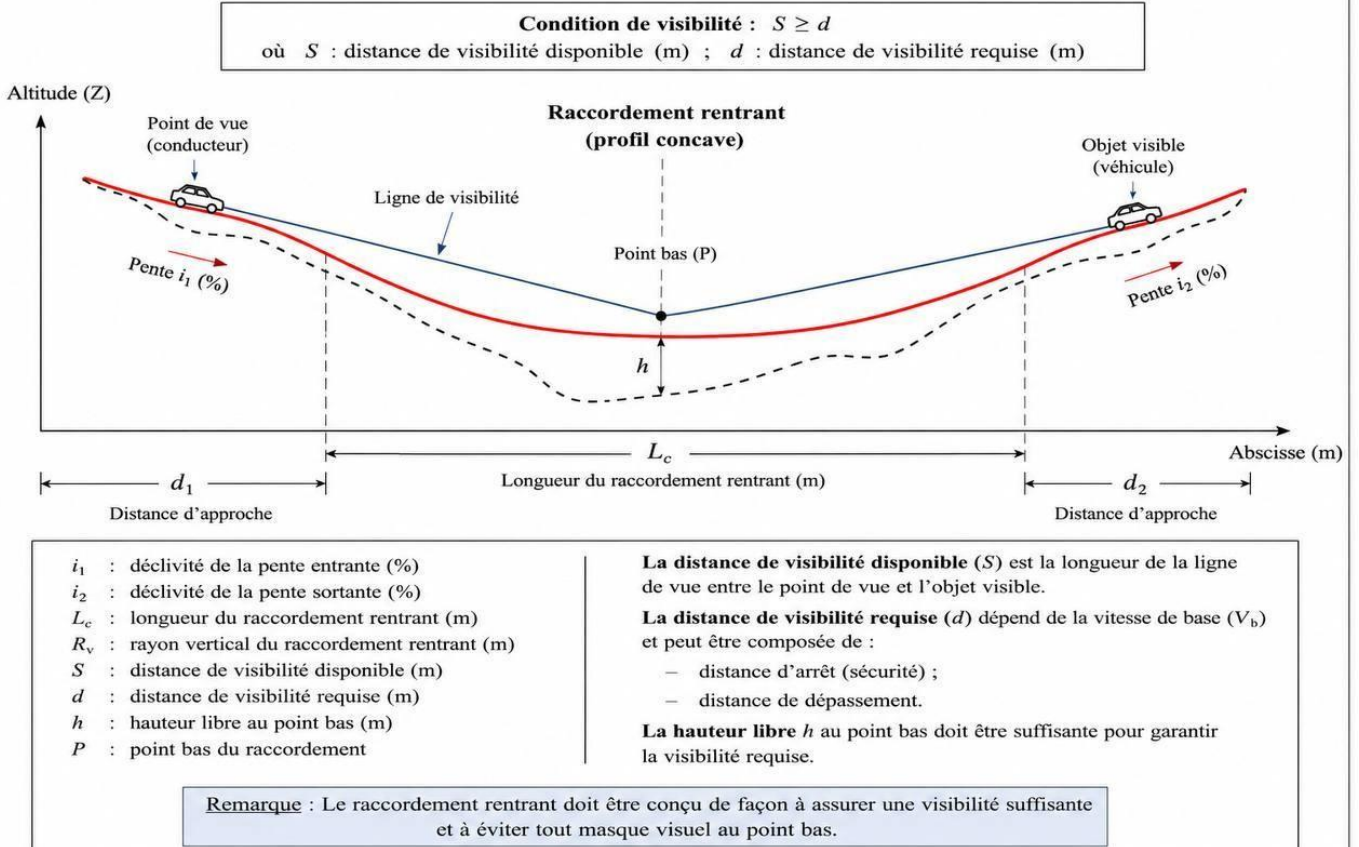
Visibilité sur un raccordement rentrant (profil concave)
